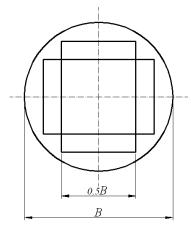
Ортогональная арматура в круглых отдельных фундаментах на грунте
